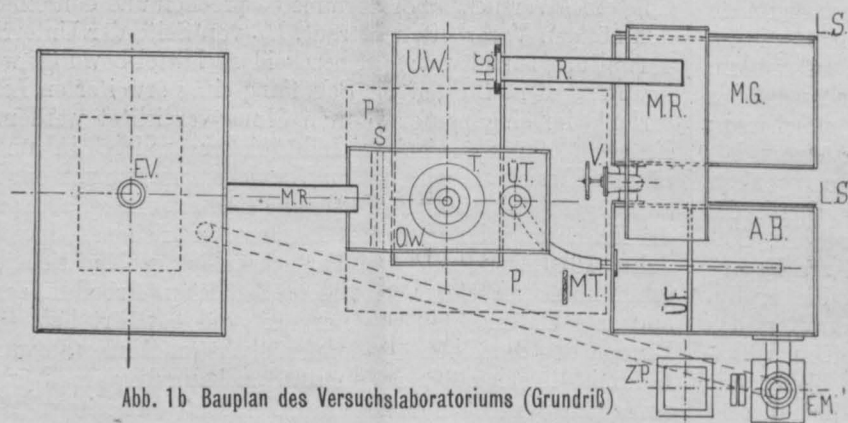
Bauplan des Versuchslaboratoriums (Grundriß)
